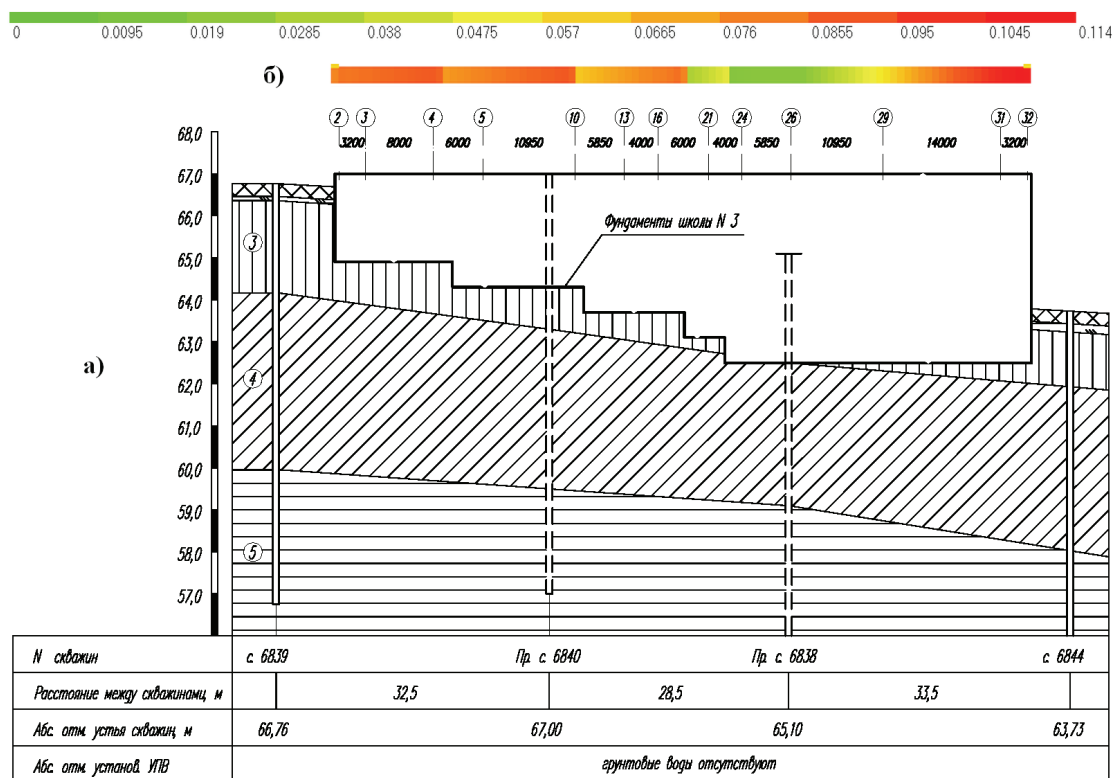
Инженерно-геологический разрез: а) инженерно-геологический разрез вдоль главного фасада школы; б) изополя вертикальных деформаций основания по длине фундамента.
